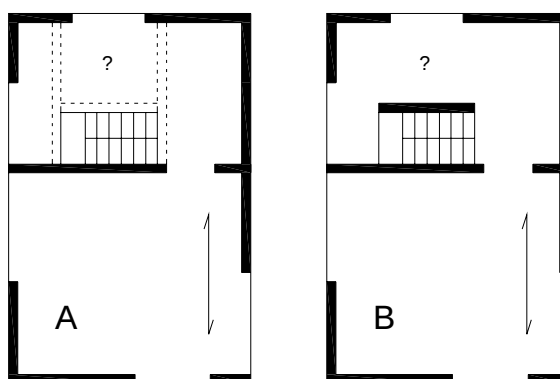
Disposizione in pianta dei solai. L'apertura del vano scale deve essere rinforzata con travi (tratteggiate) come in A, oppure deve essere presente un muro per appoggiare il solaio come in B.
